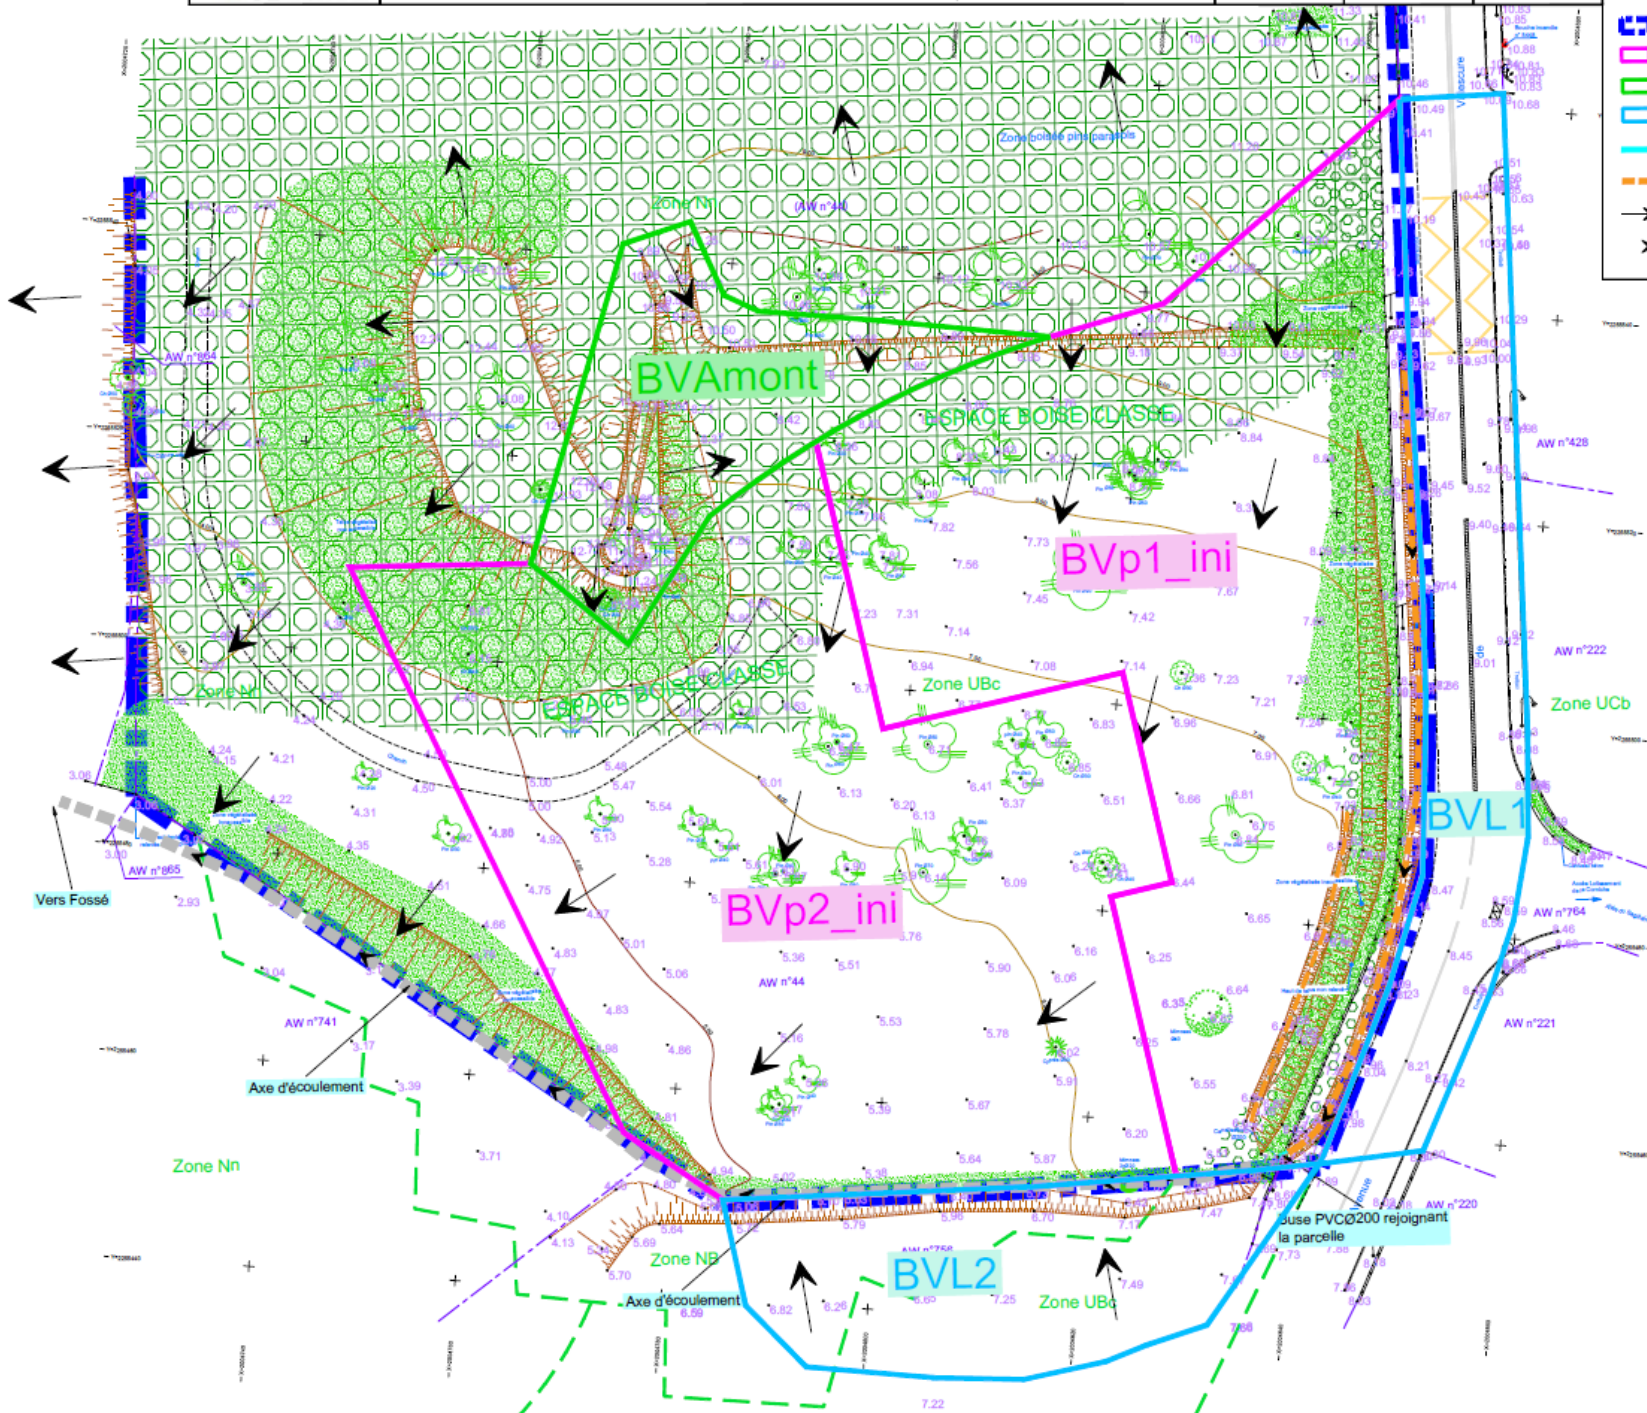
Plan des bassins versants sur fond de plan topographique - situation actuelle (Source : Note hydraulique réalisée par Alizé environnement)
